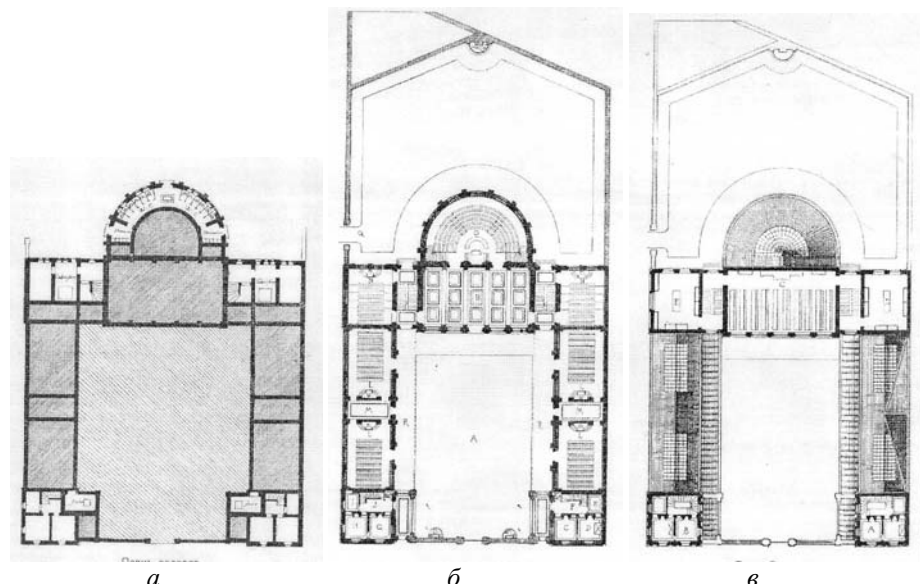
Планы Высшей школы коммерции: *а* — план цокольного этажа; *б* — план первого этажа; *в* — план второго этажа. Арх. Лишь (Lisch) [6]
